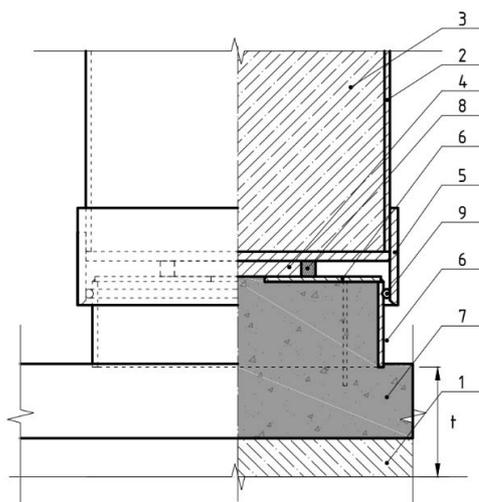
Общий вид и разрез по нижнему шарнирному узлу анкерного крепления трубобетонной опоры к монолитному железобетонному фундаменту (заявка №2021101281С002478)
